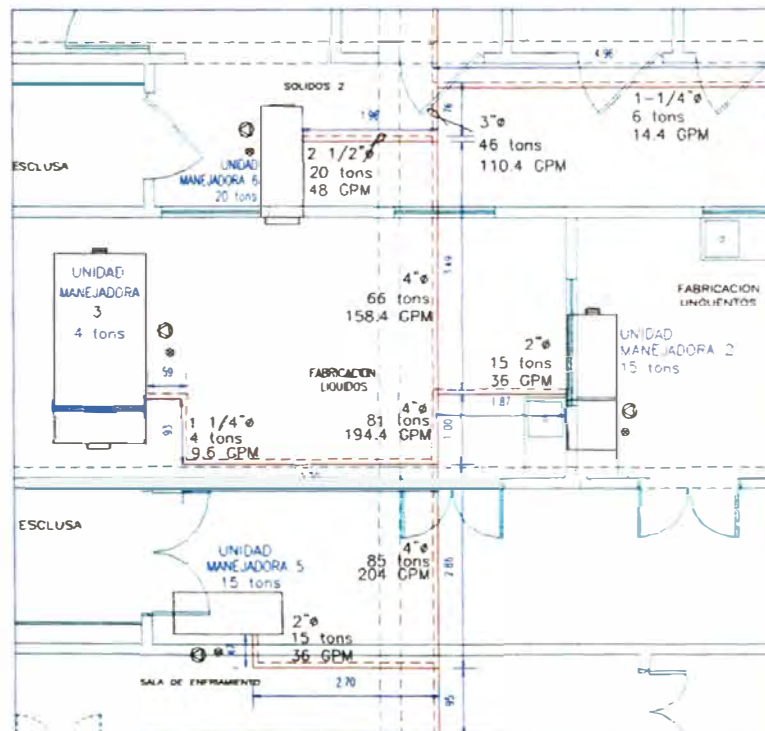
DIMENSIONAMIENTO DE TUBERÍAS DE AGUA HELDA
